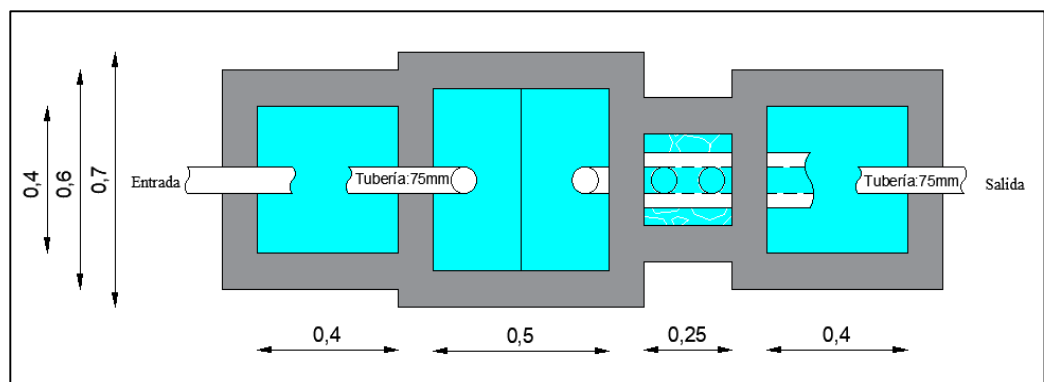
Vista en planta - Esquema de Alternativa 1 (Accesorios, materiales y medidas) OPS
